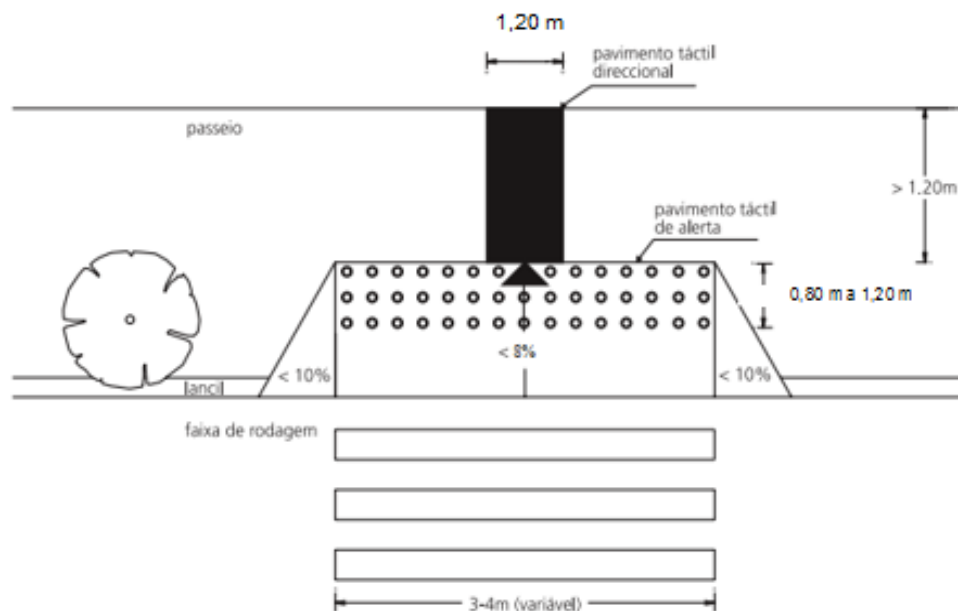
Rebaixamento de Lancil e passeio adjacente rampeado
